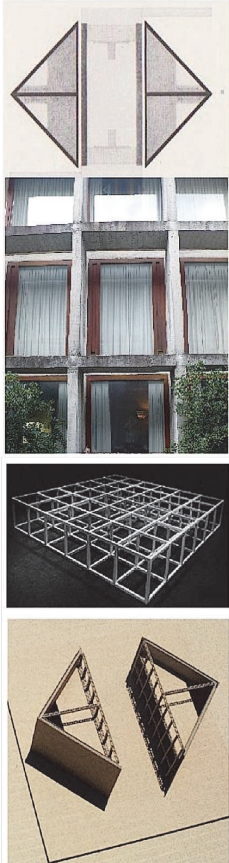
La structure constructive s'incarne dans une figure spécifique. La poutre principale qui supporte la dalle de couverture recoupe le triangle en deux parties en induisant une nouvelle géométrie interne. A l'image de la grille infinie de Sol Lewitt, le dispositif structurel acquiert une valeur représentative.
